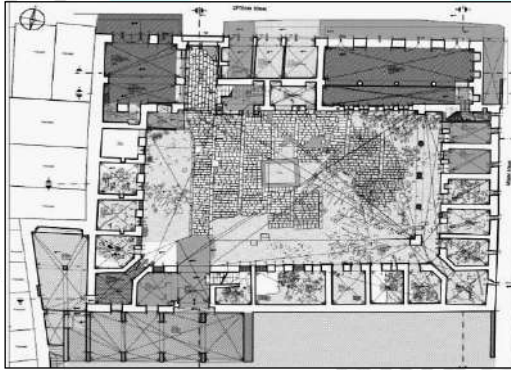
Sülüklü (Kazancı) Hanı Planı
